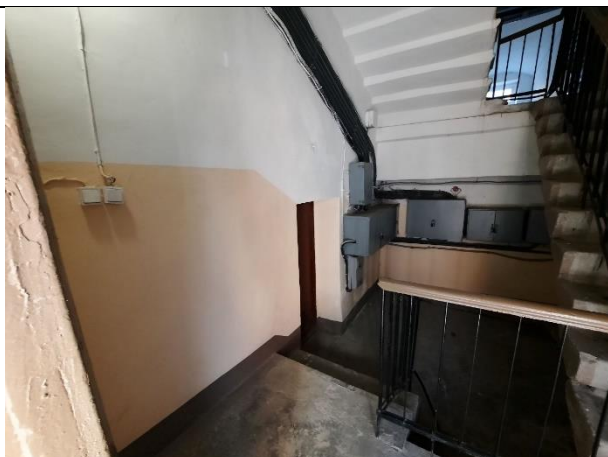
Общий вход в здание, ведущий ко входу в помещение с лестничной клетки
